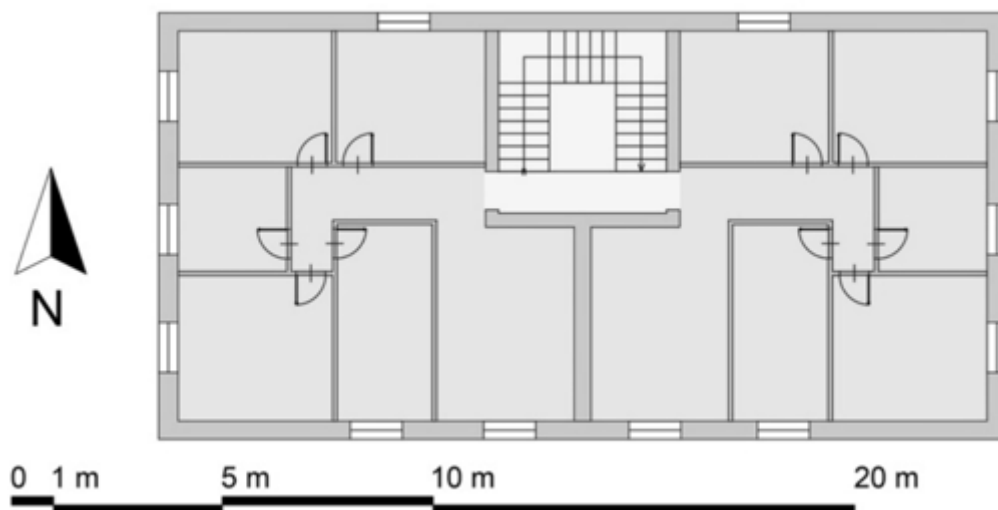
Planimetria del piano tipo dell'edificio residenziale
